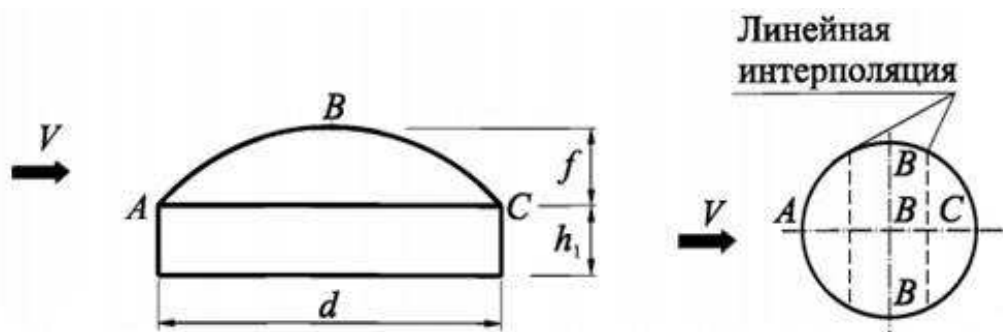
Схема действия ветровой нагрузки на сводчатые покрытия
